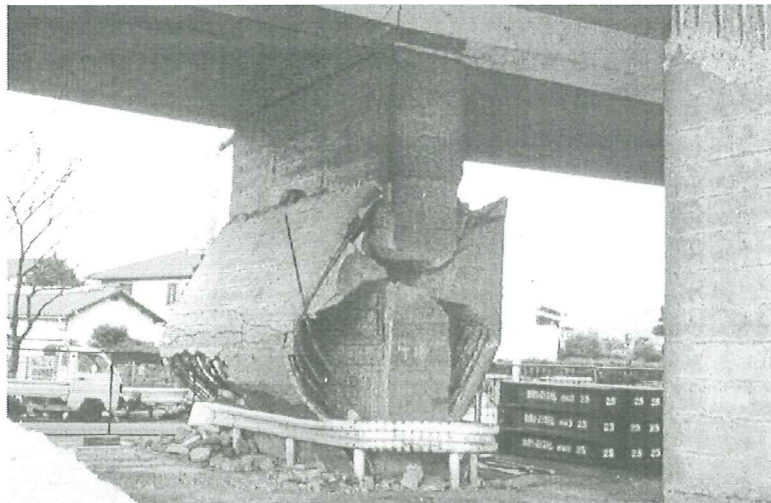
Colapso de una pila pantalla de hormigón armado, Nishinomiya, (Architectural Institute of Japan Society of Civil Engineers).
